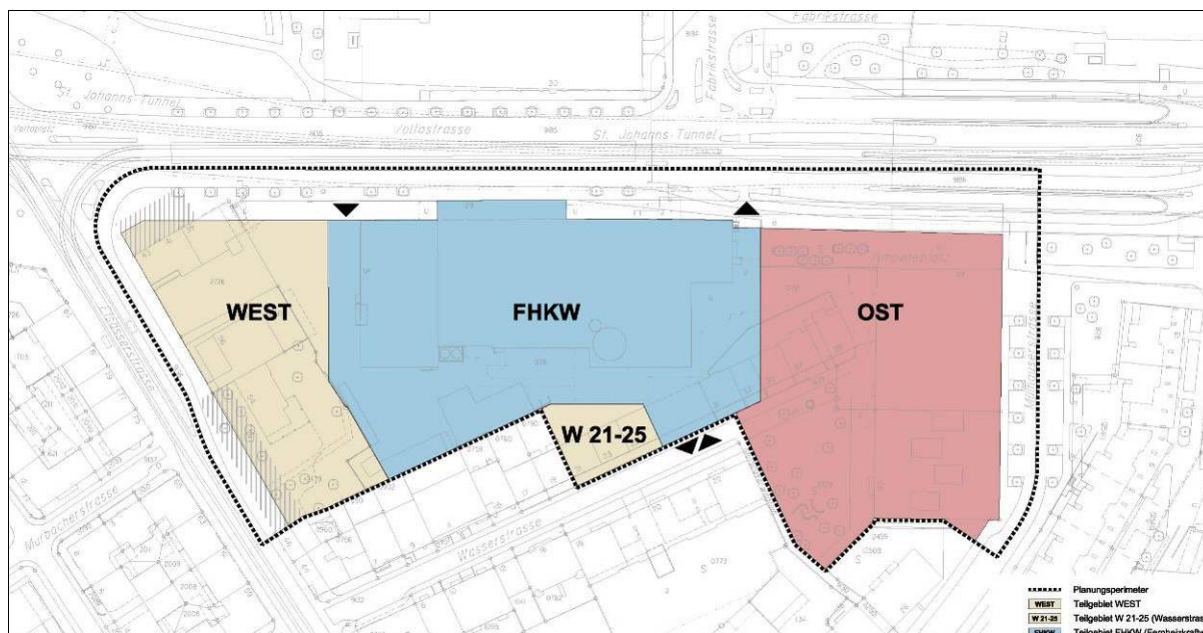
Bebauungsplan. Plan Nr. 13'585 (genordet, ohne Massstab).
